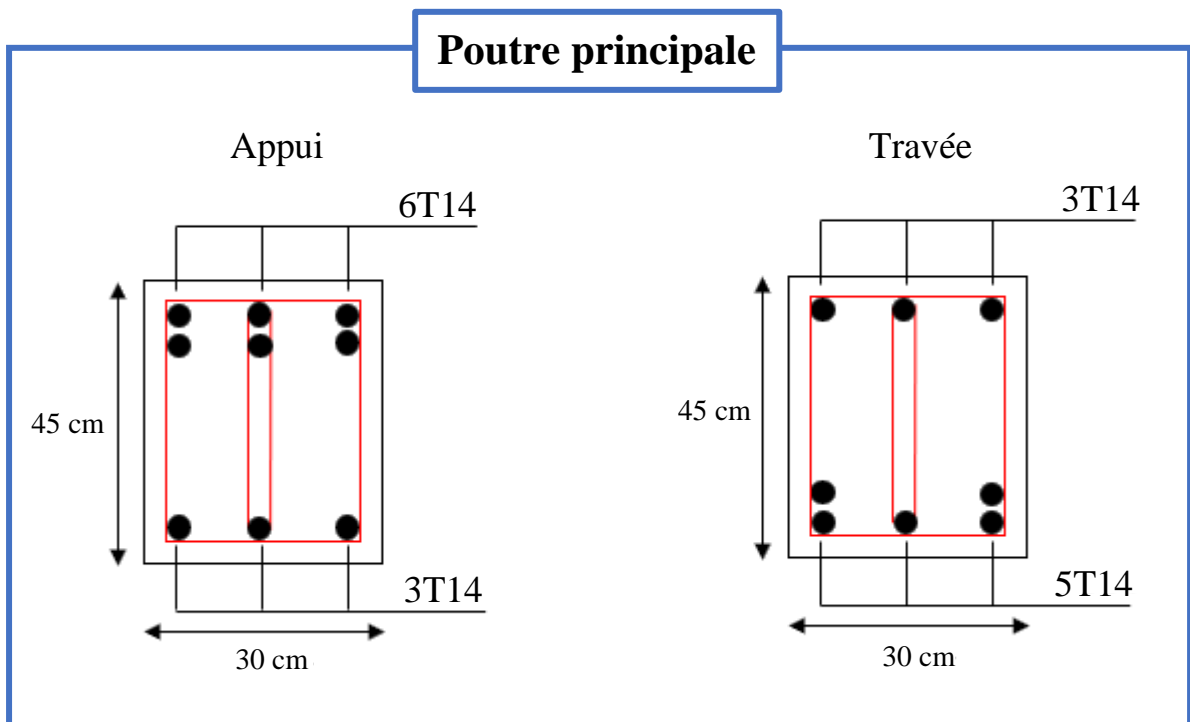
Schéma de ferrailage des poutres principales (RPA/v24).
